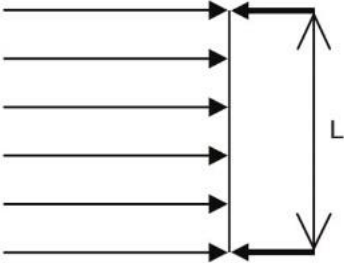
, Таблица 2. Нагрузки на стеновые панели с минераловатным утеплителем. Схема нагружения — однопролетная балка.
